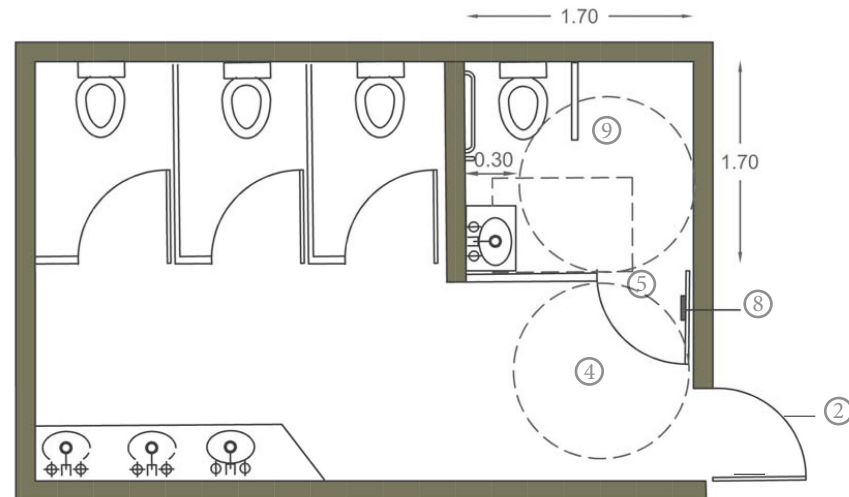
2 Sanitario general con cubículo con lavabo - Planta
